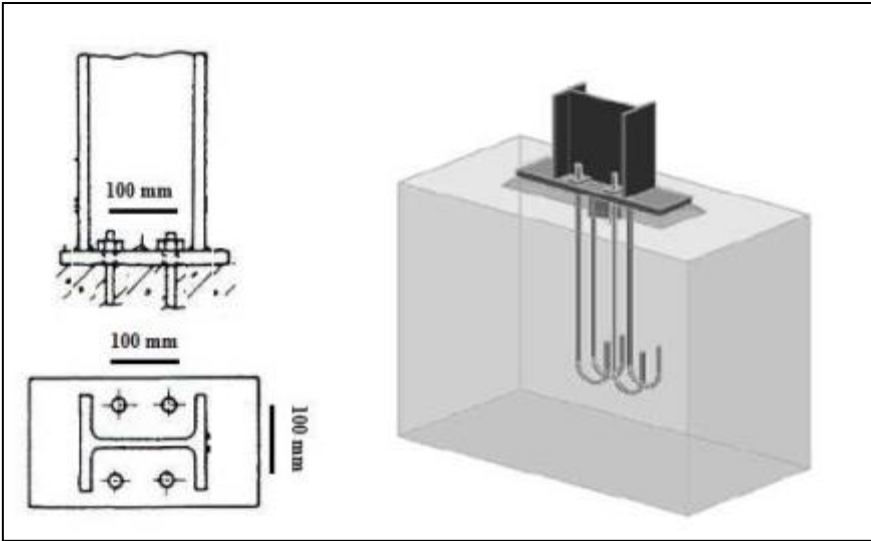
Pied de poteau articulé avec 04 boulons d'ancrage.
